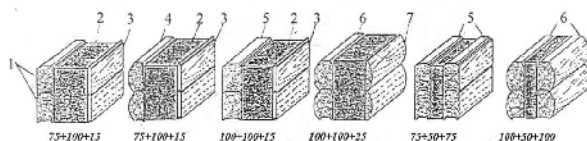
33. Конструкции деревянных стен сэндвичного типа: 1 – деревянный брус; 2 – утеплитель; 3 – доска внутренней обшивки; 4 – полубревно; 5 – оцилиндрованный брус; 6 – полубревно
